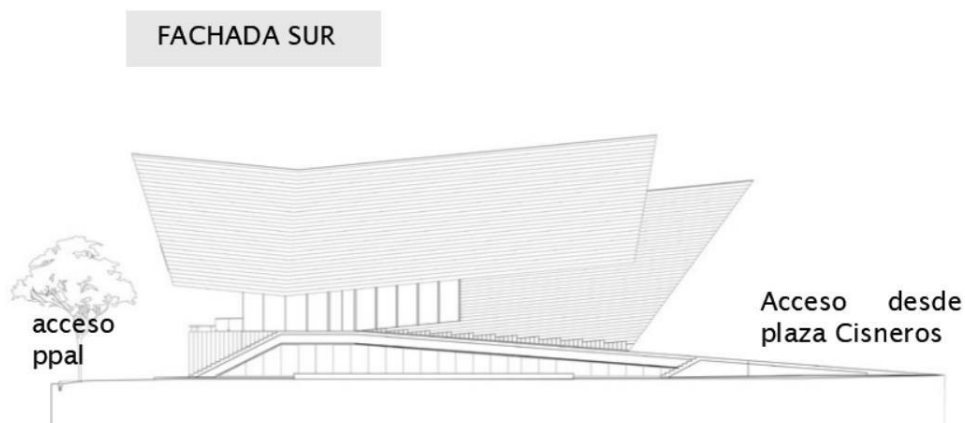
, Fachada sur Biblioteca EPM, integración del espacio urbano.
